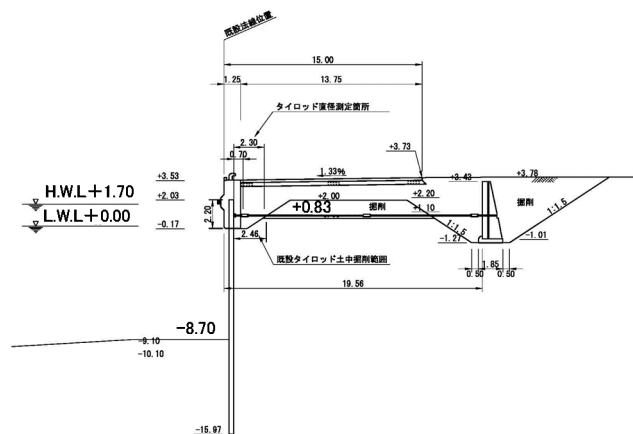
苫小牧港西港地区岸壁(-9m)断面図
